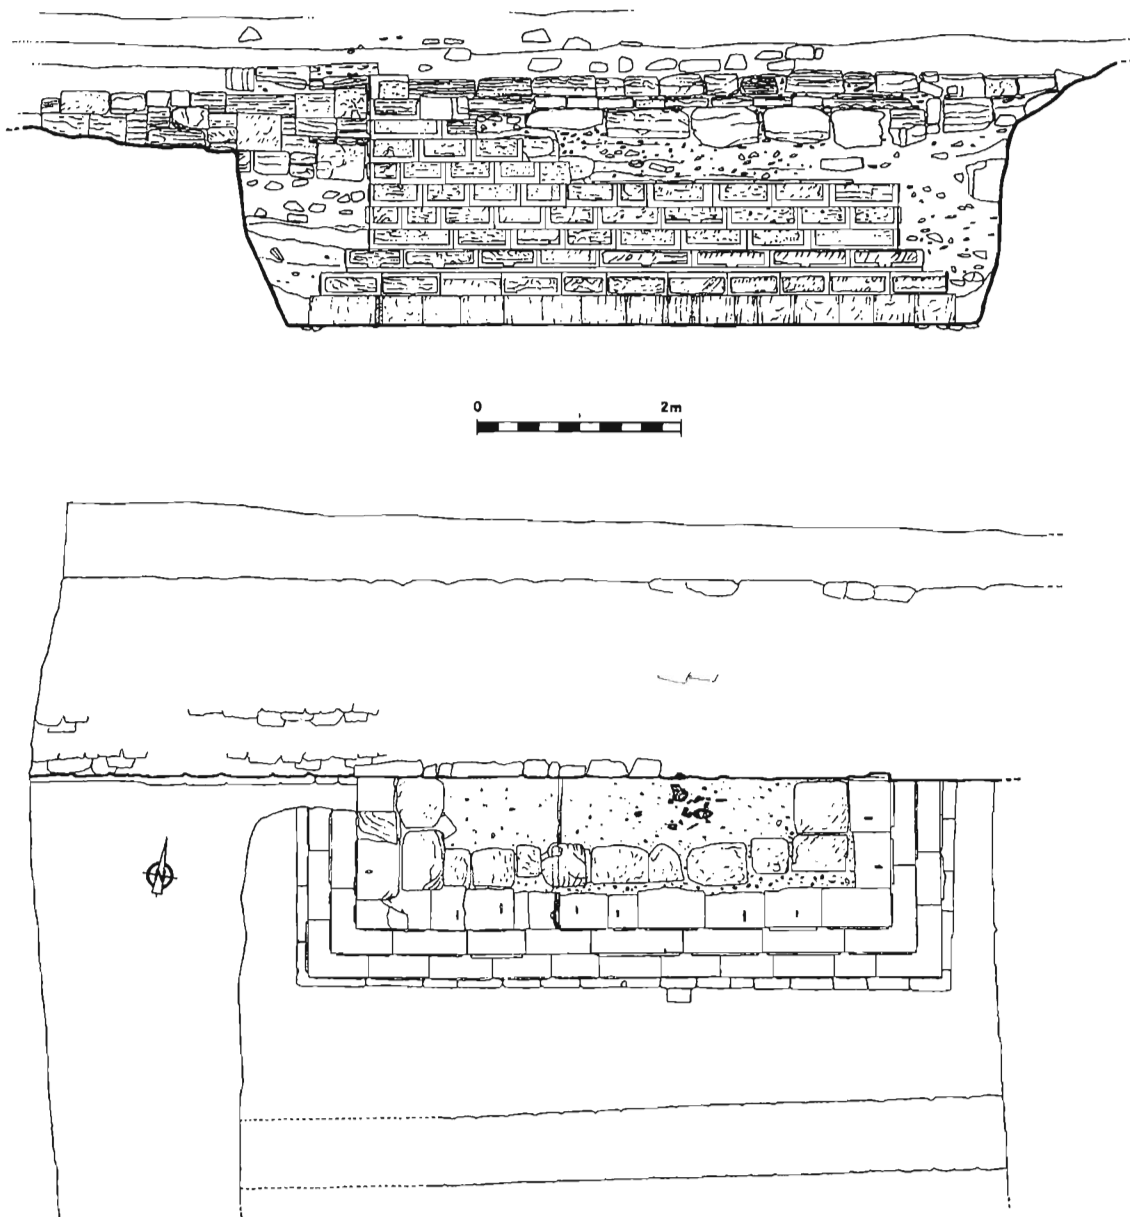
Efestia. Il monumento presso le mura dell'istmo, prospetto e planimetria (ril. Treerre di G. Tilia, 1996).
